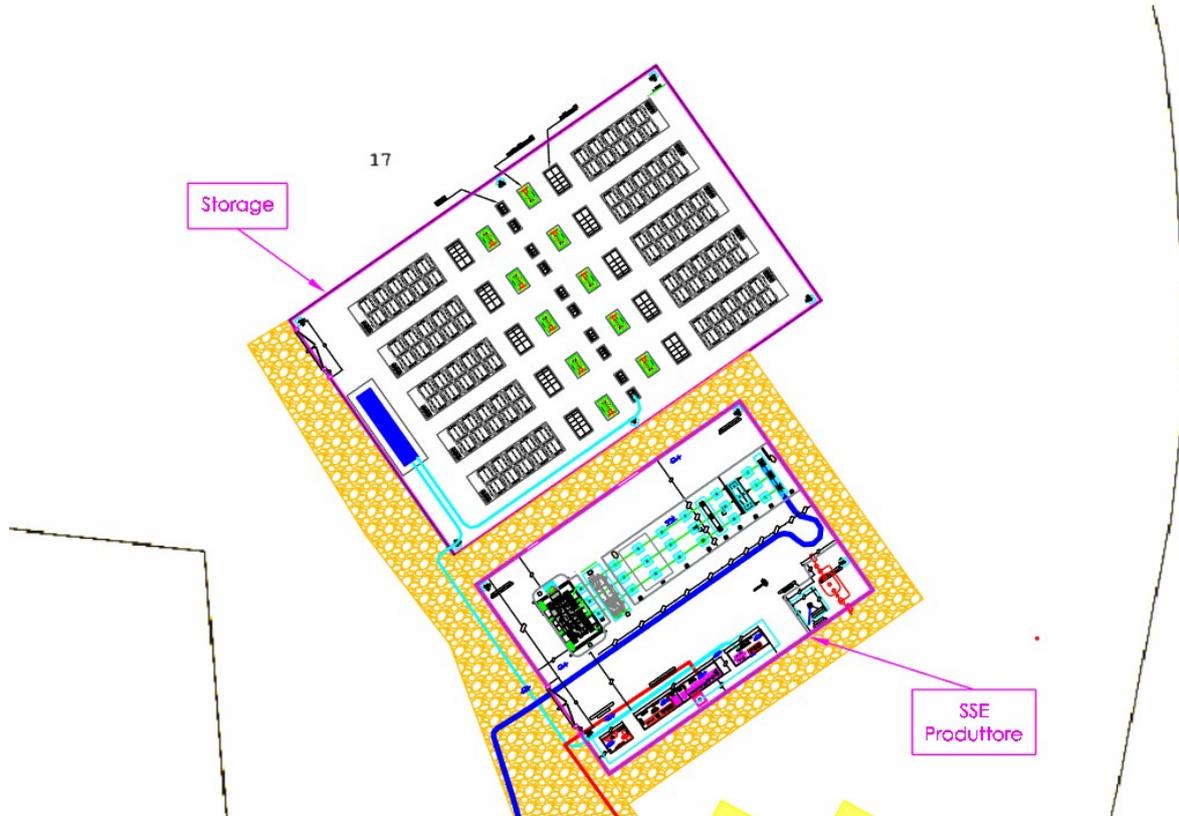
Layout della Stazione di accumulo, su planimetria catastale, e posizione reciproca rispetto alla futura SSE Produttore
